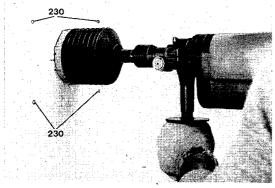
Bohren des Mauerdurchbruches nach hinten (Öffnungsbohrungen 100 mm)
